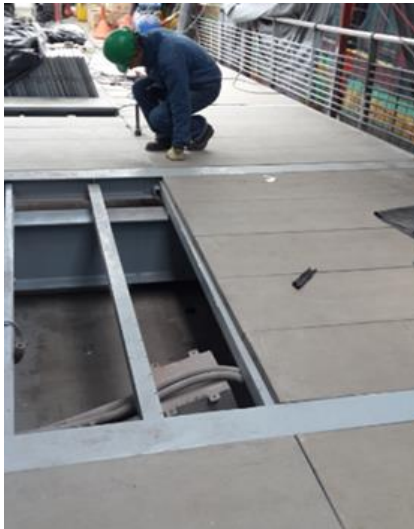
Rejilla de polyconcreto para alcantarillado
